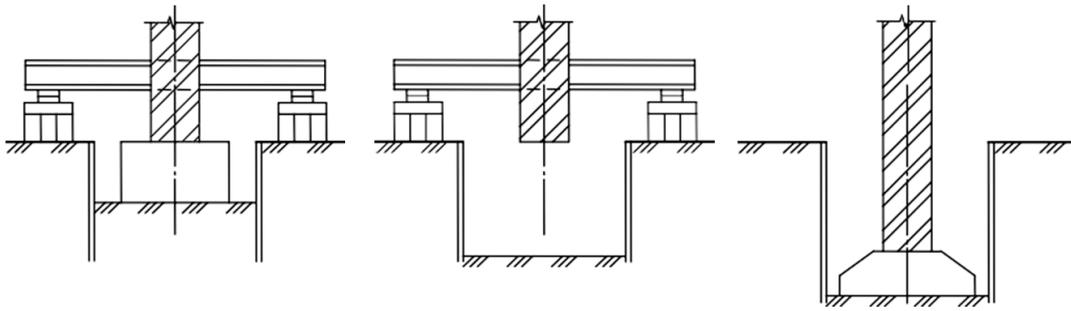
Переустройство ленточного фундамента с разборкой старой кладки фундамента
